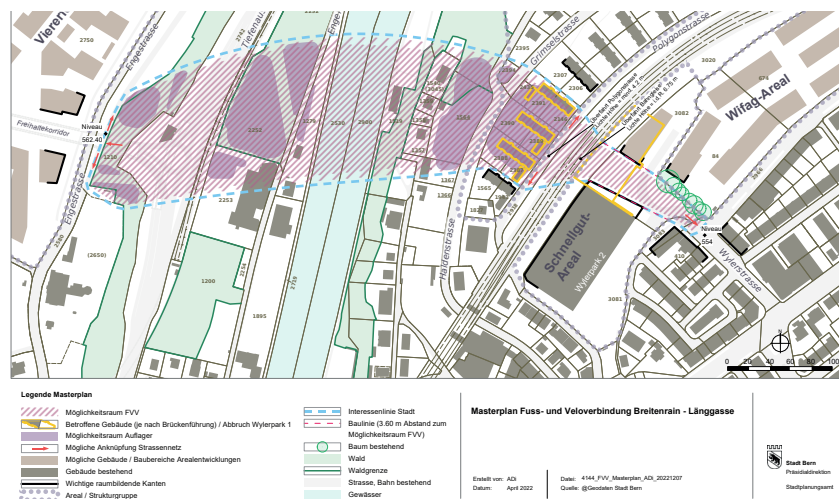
Masterplan Fuss- und Veloverbindung Breitenrain - Länggasse, Stadtplanungsamt Stadt Bern
